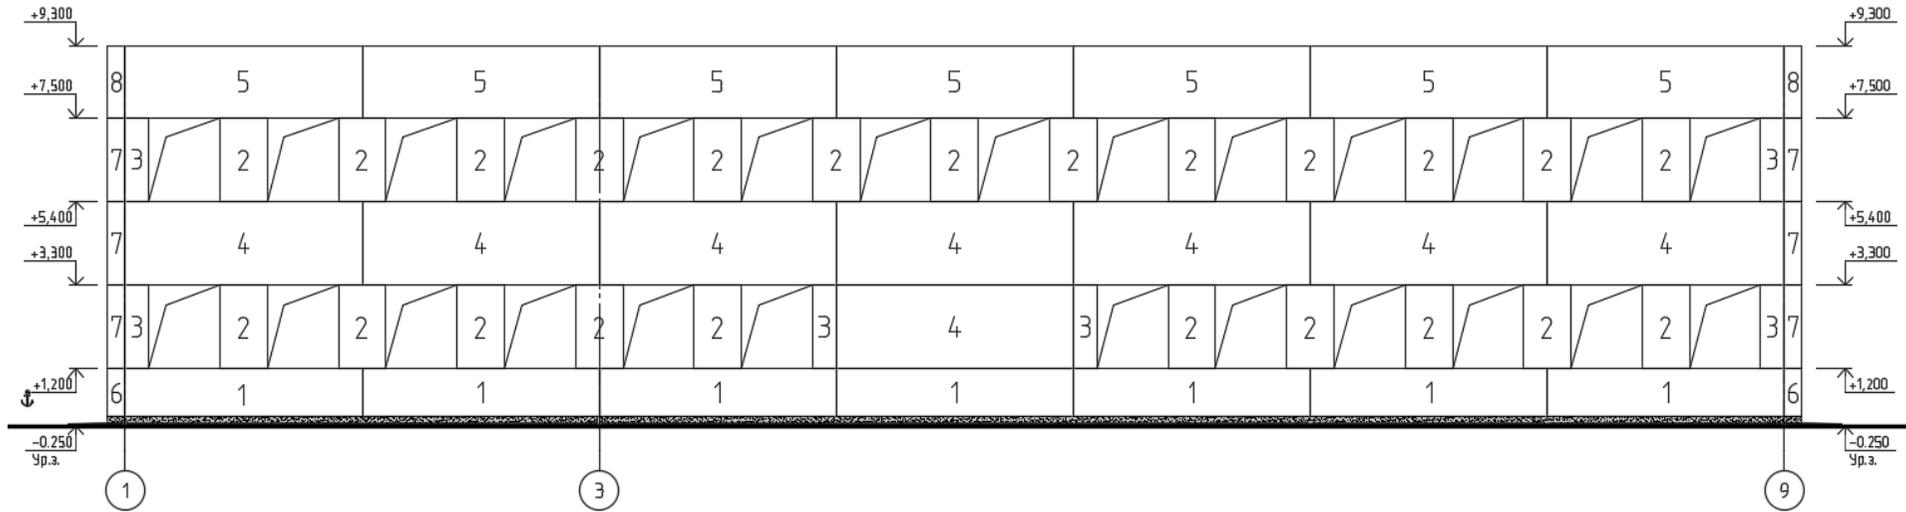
Схема расположения стеновых панелей на фасаде 1-9
